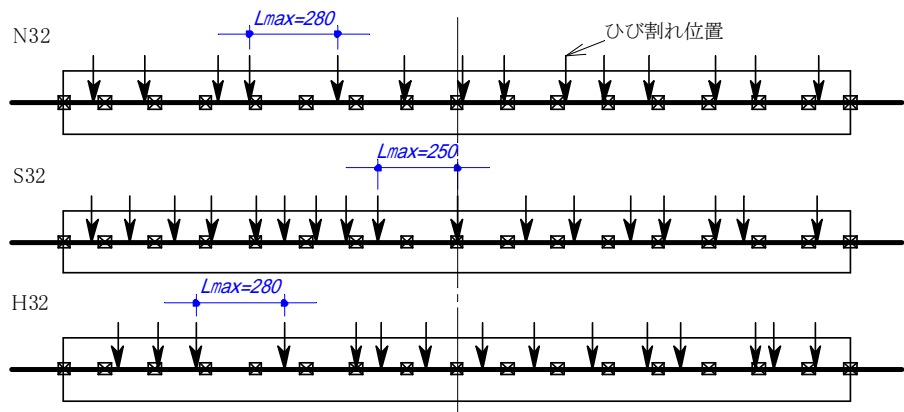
ひび割れ発生状況の例(鉄筋：D32)
